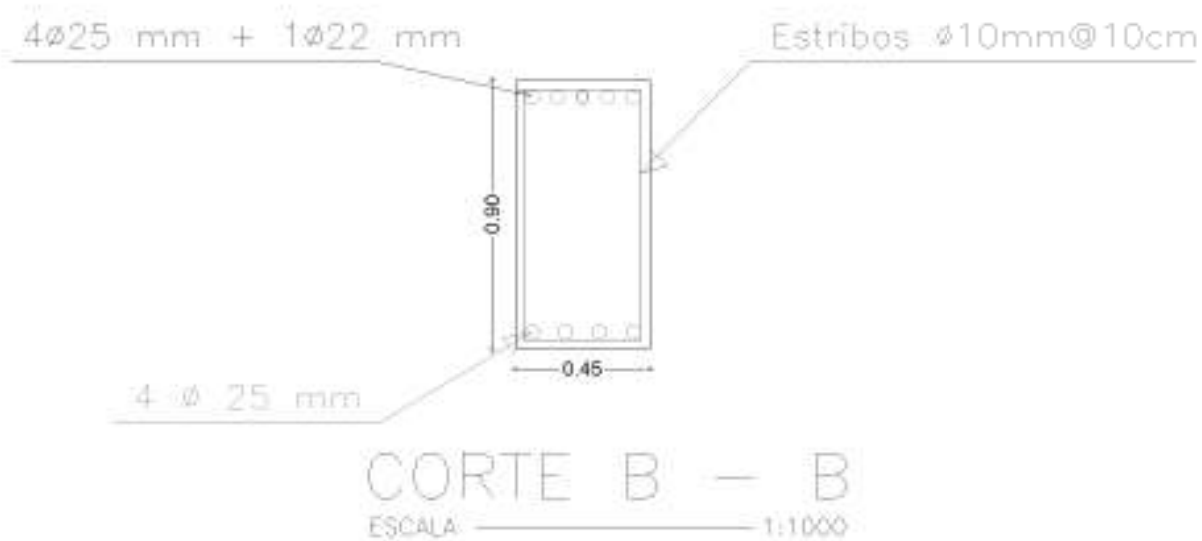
Armado de viga 2 Piso, pórtico 3
